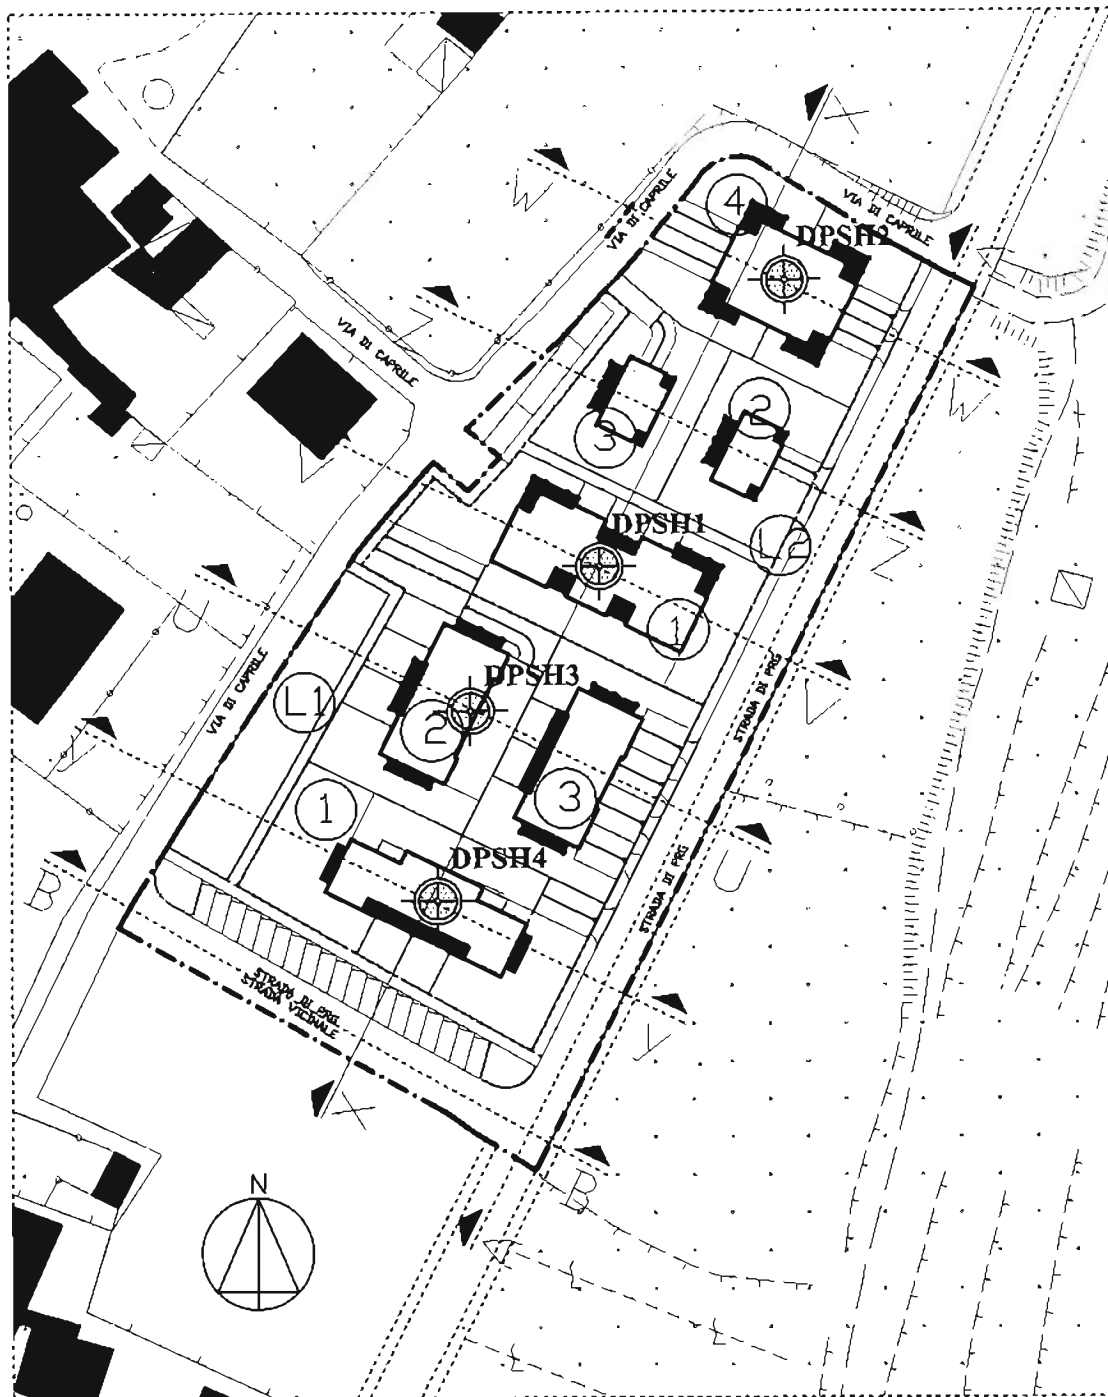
Planimetria di progetto in scala 1:1000 con l'ubicazione delle prove.
